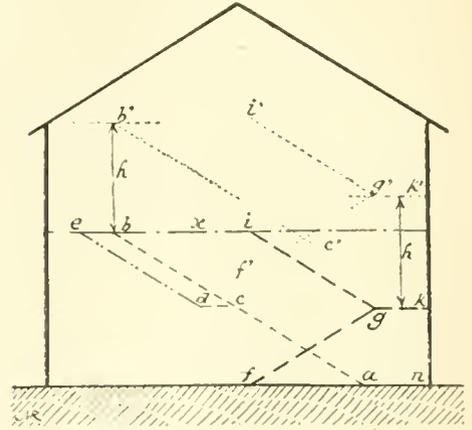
Tracé d'escaliers dans le plan vertical.
